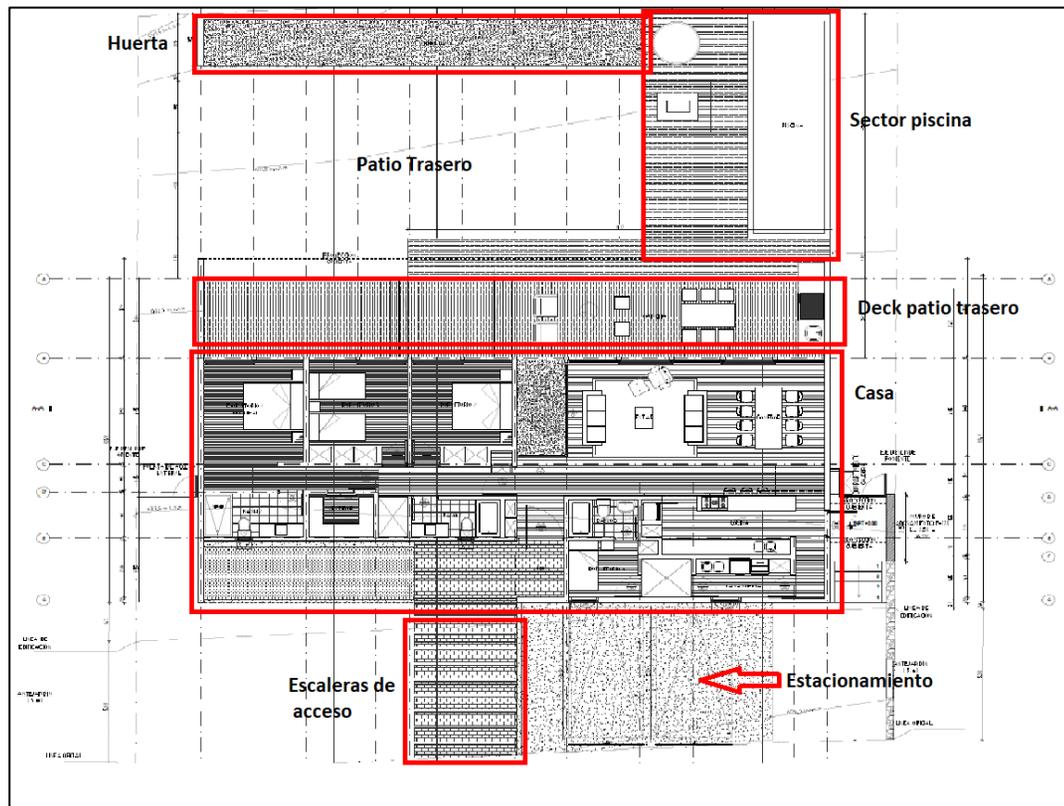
Esquema de plano en planta de vivienda Condominio La Reserva, Colina.
